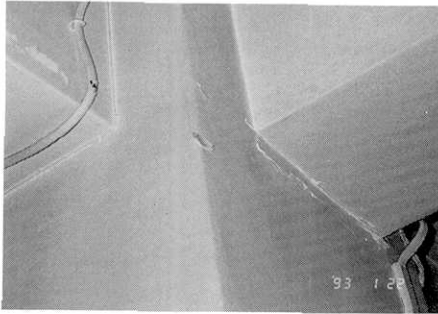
2階中柱の柱頭の曲げひび割れ
